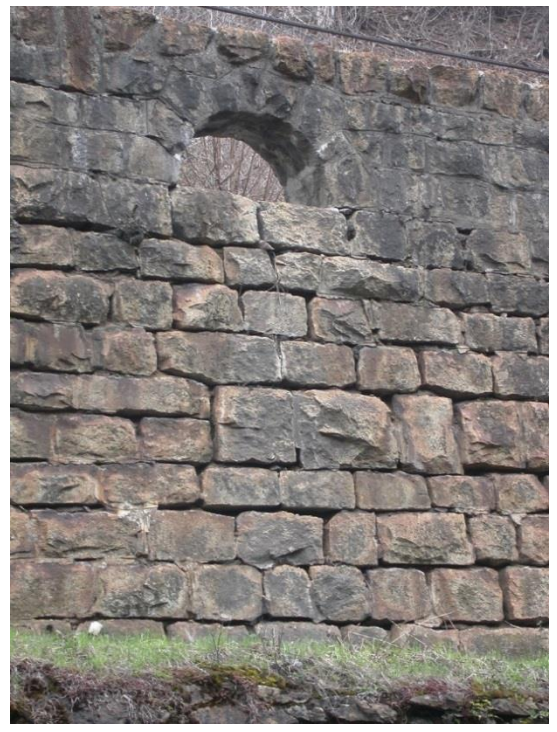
quelques pierres libres (cause détérioration du mortier)
